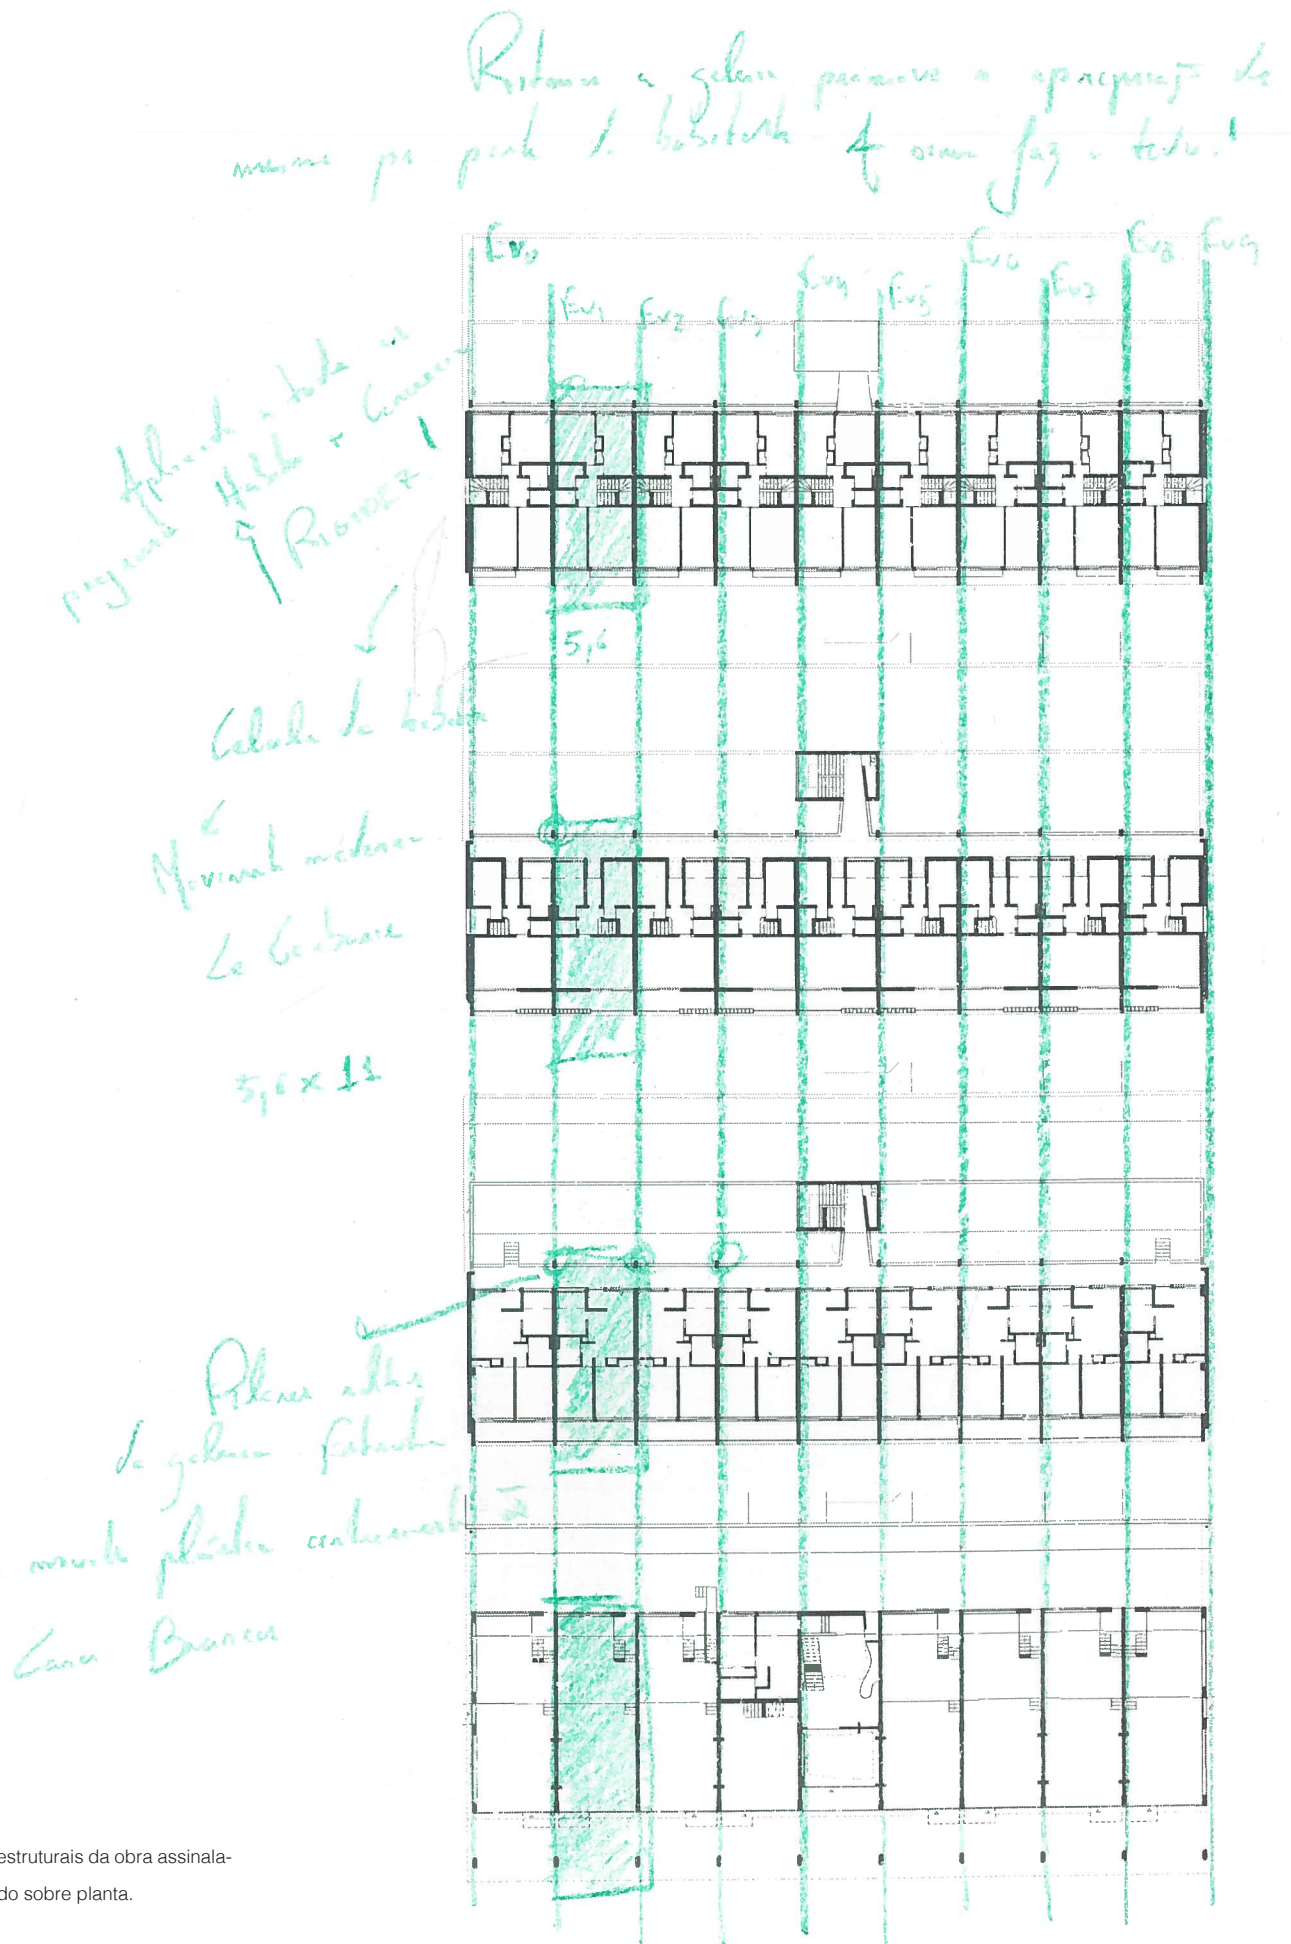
Eixos estruturais da obra assinalados a verde, estudo sobre planta.
